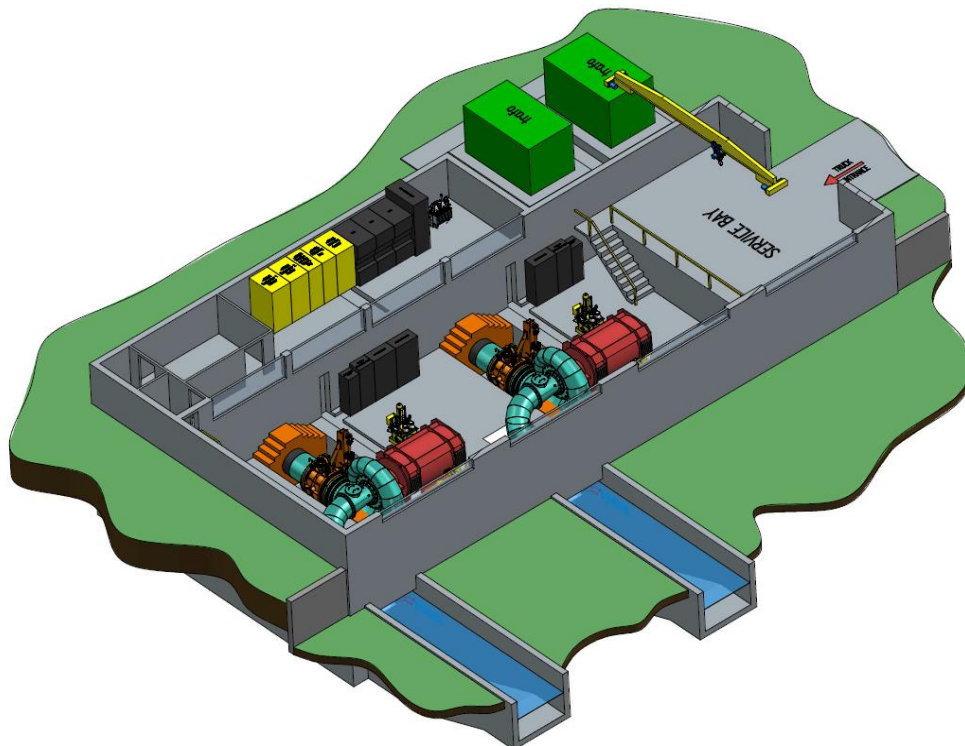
Esquema Planta de casa de máquinas. Fuente: GENSA
